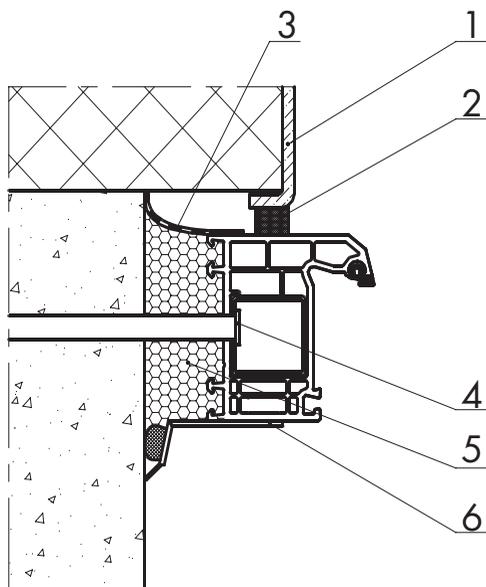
Узел бокового примыкания оконного блока к проему стены из бетона с наружным утеплением фасада и установкой внутреннего декоративного нащельника с пароизоляционной системой
